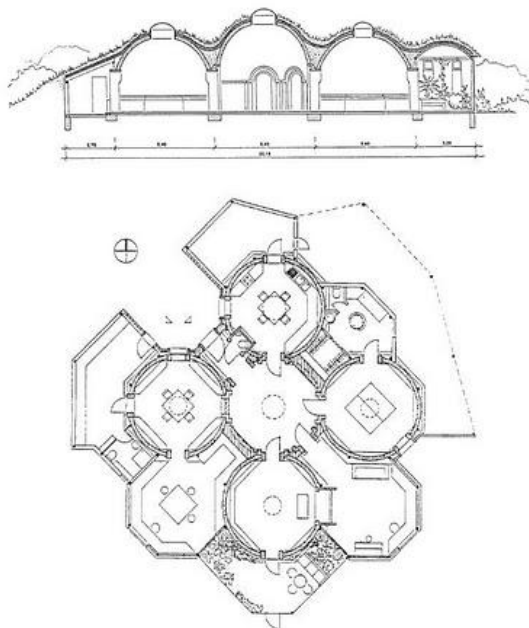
Entrada / Pormenores do Edifício / Corte / Planta / Construção de uma das cúpulas
